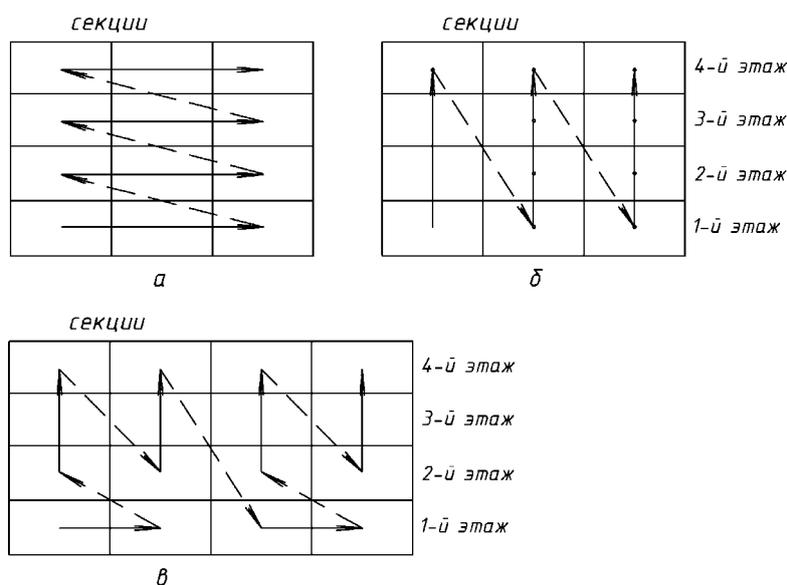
Схемы направления монтажа многоэтажных зданий:
